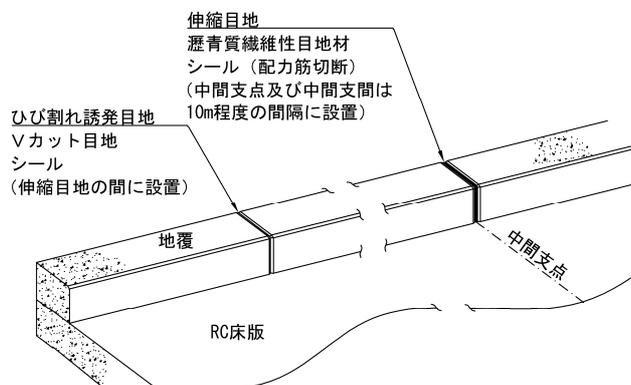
伸縮目地及びひび割れ誘発目地及びの配置
